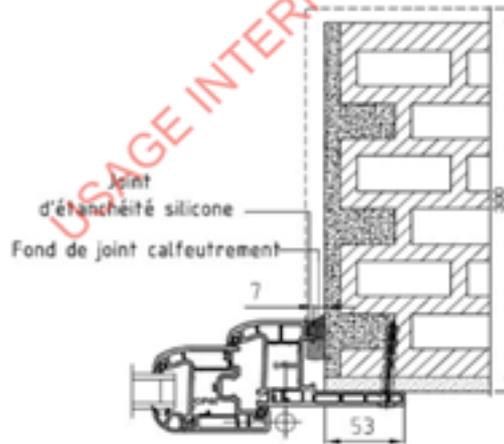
Fixation du dormant de la menuiserie en PVC en façade
